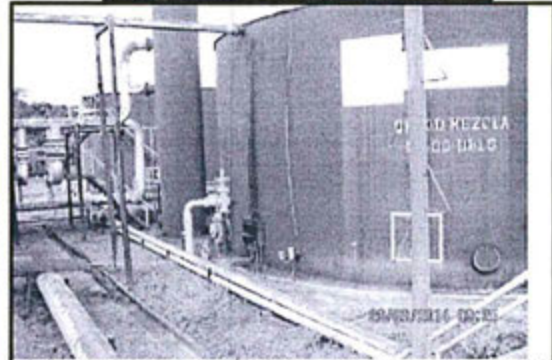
E0:06059 N9695935 /Área estanca de los Tanques de Almacenamiento - Batería Jibarito/ Yacimiento Jibarito
